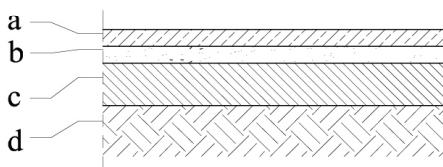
Sezione tipo di pavimentazione esterna di tipo stradale su suolo con strato ripartitore (Norma UNI 11322 cap.7.2.1.1.1)
